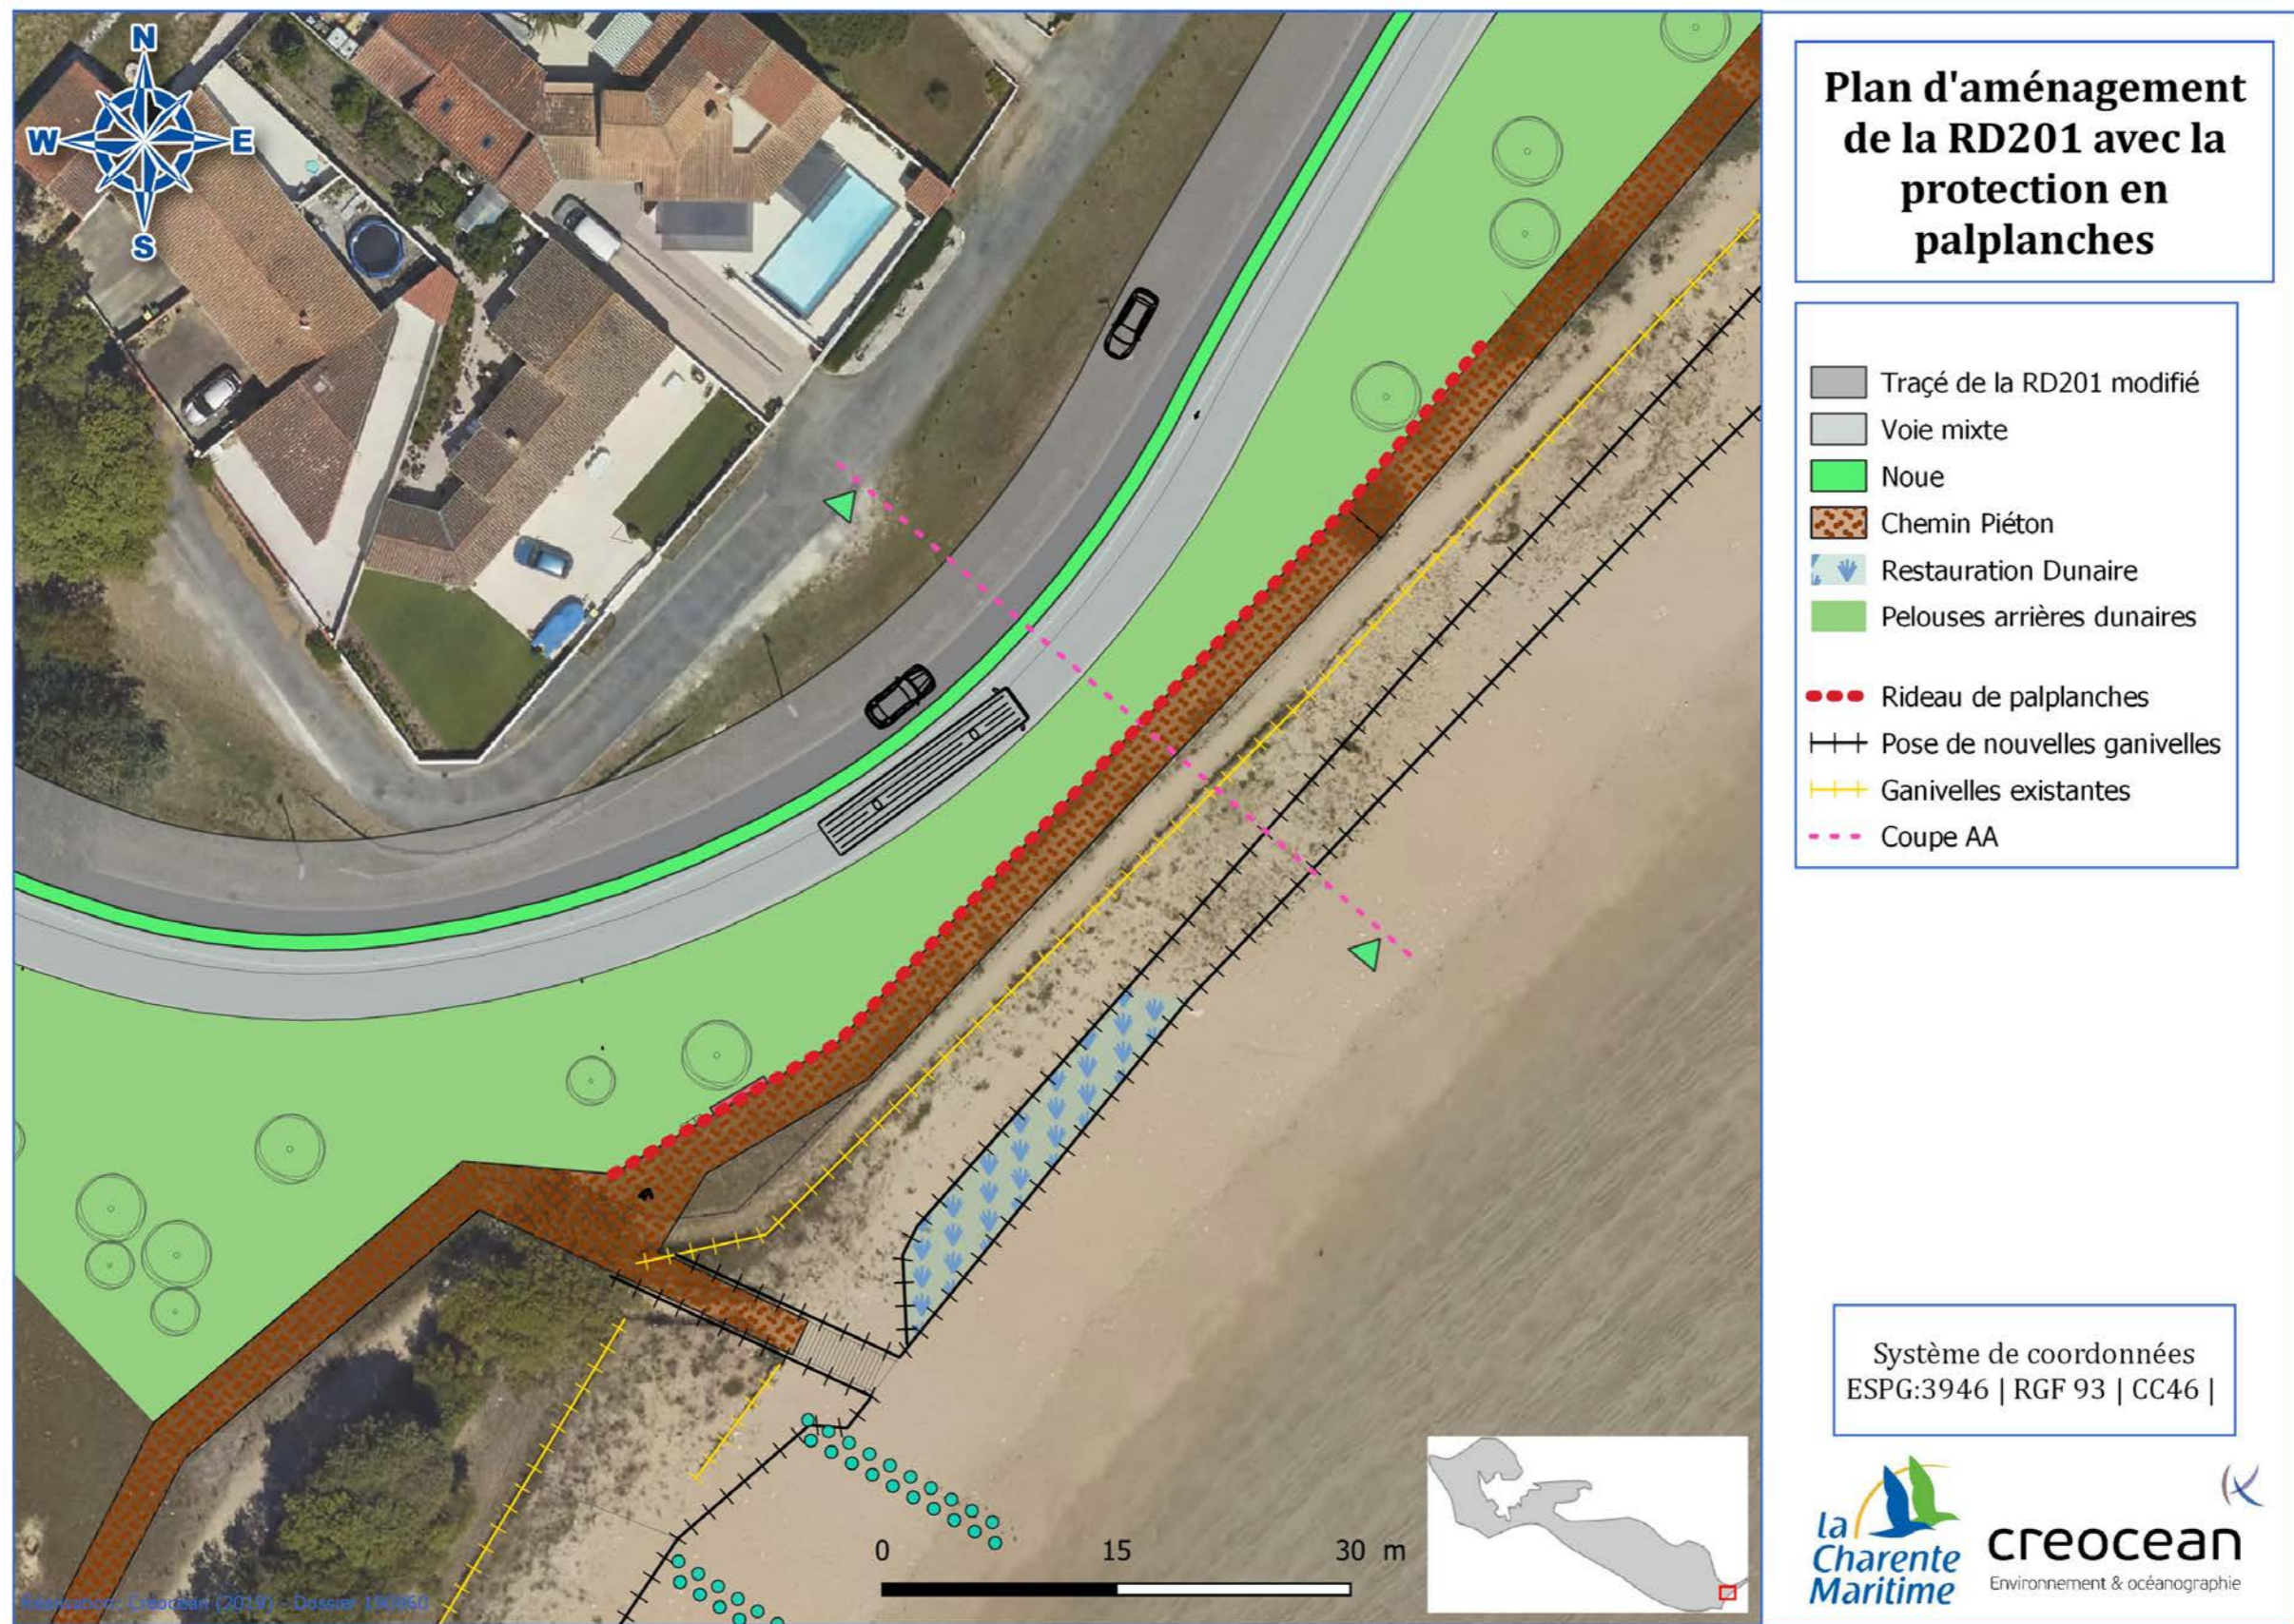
Plan d'aménagement de la RD201 avec le rideau de protection en palplanches.
